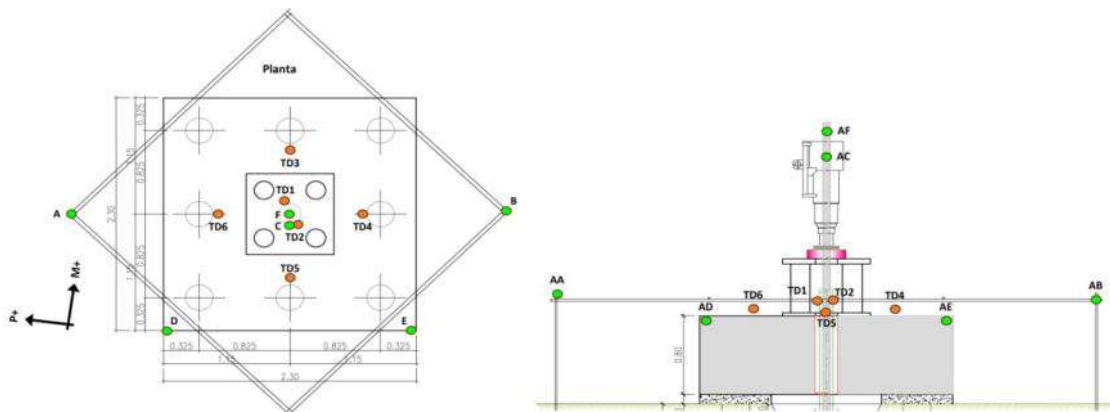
Vista em planta e alçado do maciço de reação do ensaio de carga e localização esquemática dos extensómetros e alvos topográficos
